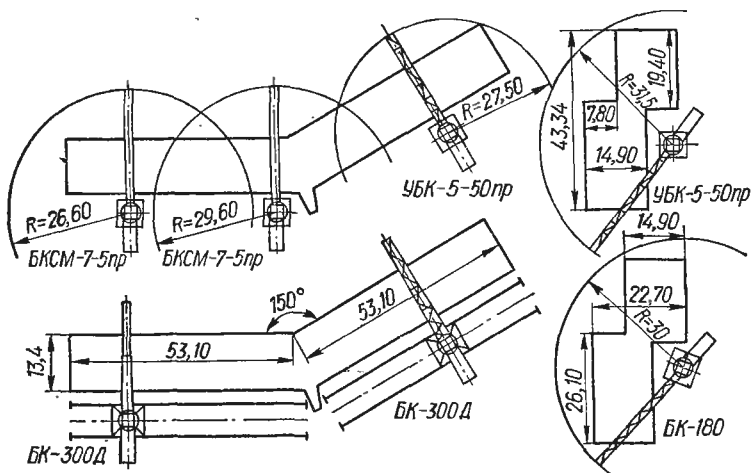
Примерные схемы расположения башенных кранов при возведении многоэтажных зданий (размеры в м).
